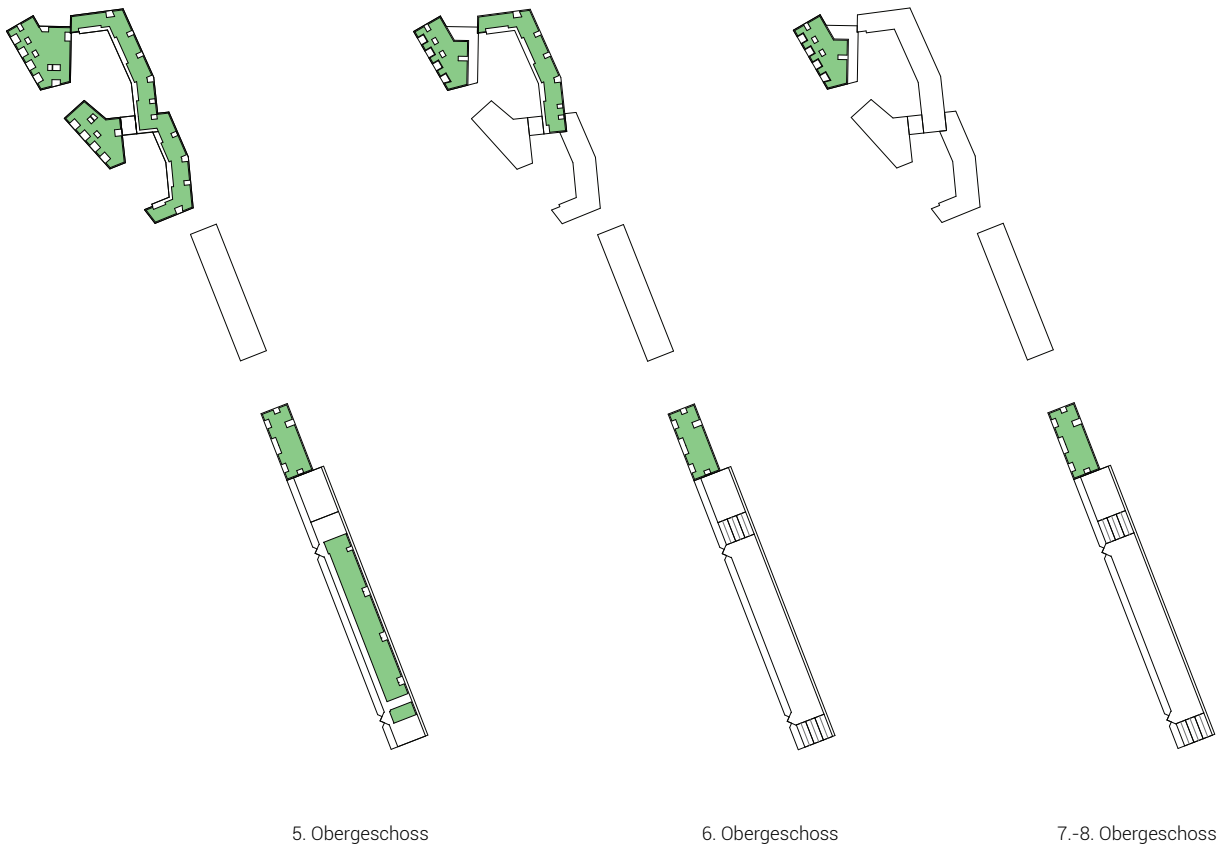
Flächendiagramme anrechenbare Geschossfläche gemäss PBG Zürich §255:1975
